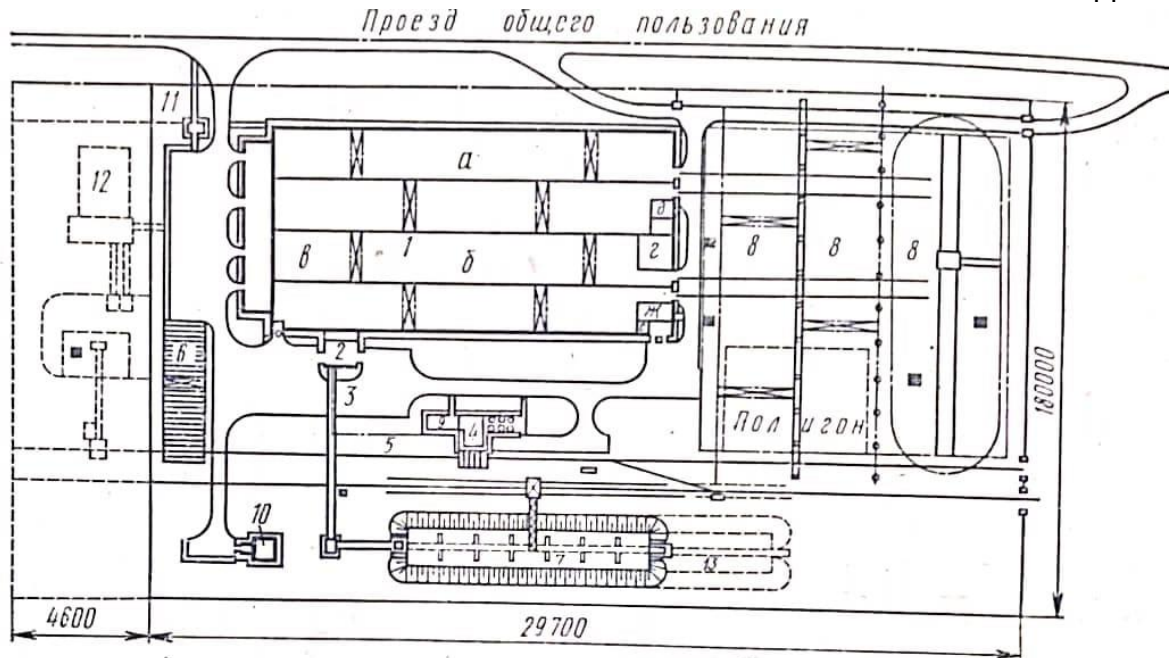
Генеральний план заводу залізобетонних виробів.
